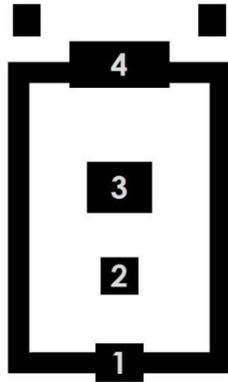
, Grundriss des Shitennoji, Japan, 593 n. Chr.
